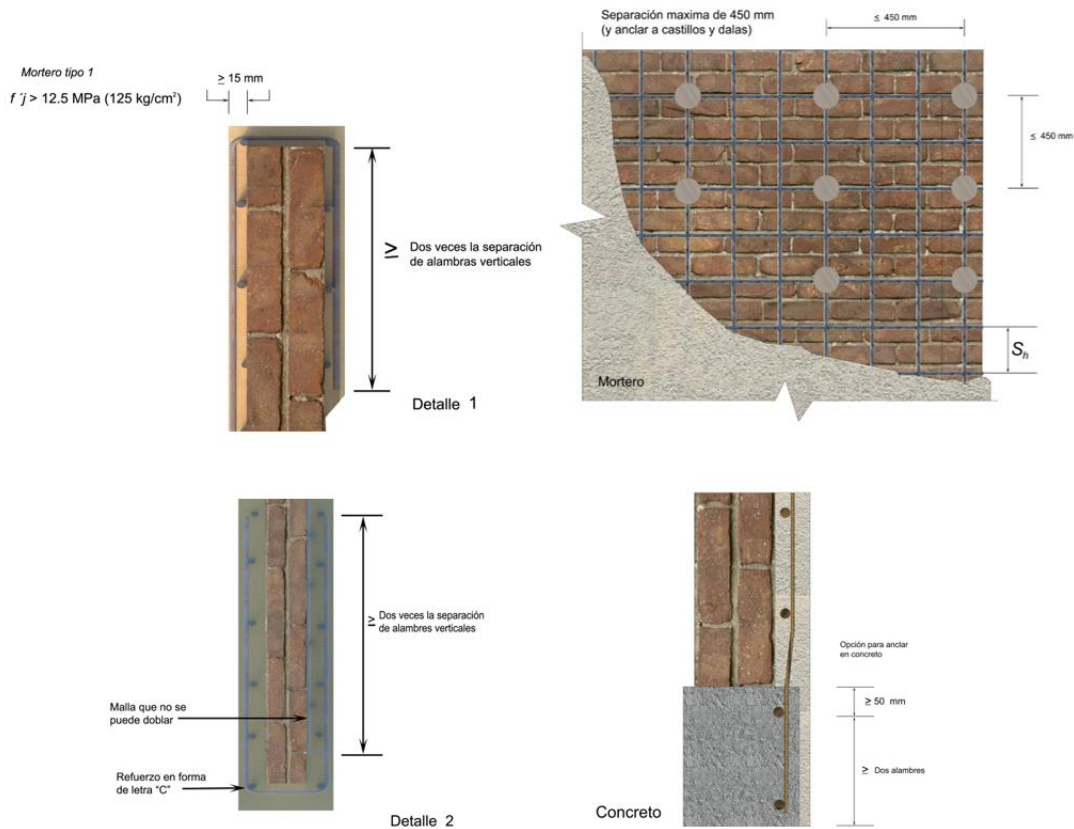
e – Detalles para la colocación de malla de alambre soldado sobre muros de mampostería
